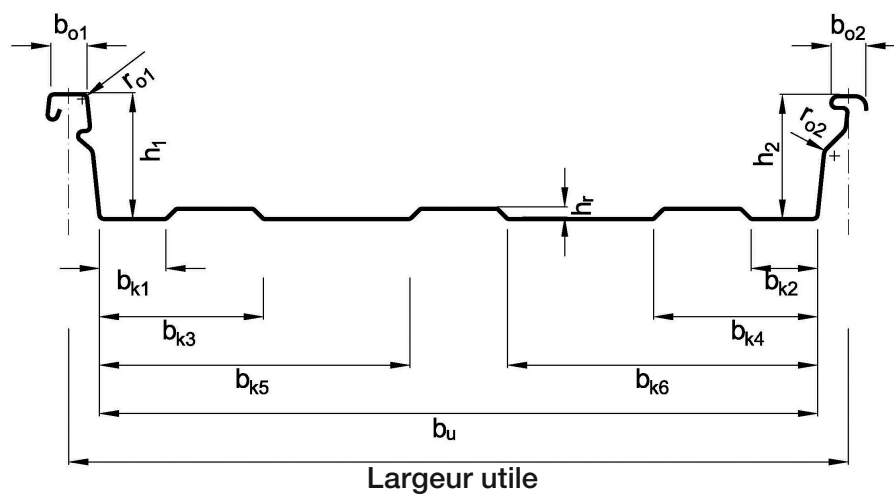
Section transversale des profilés à joint debout – type 3
